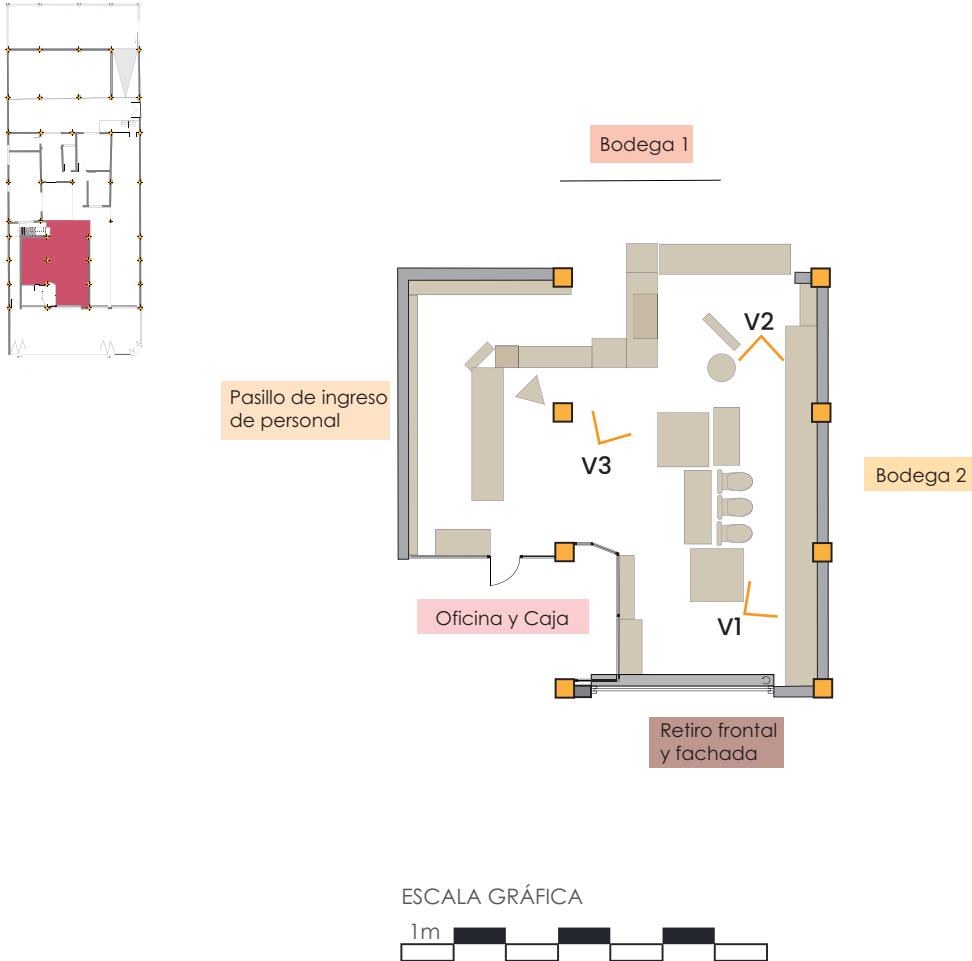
Ubicación en planta y planta detalle del área de exhibición y ventas
